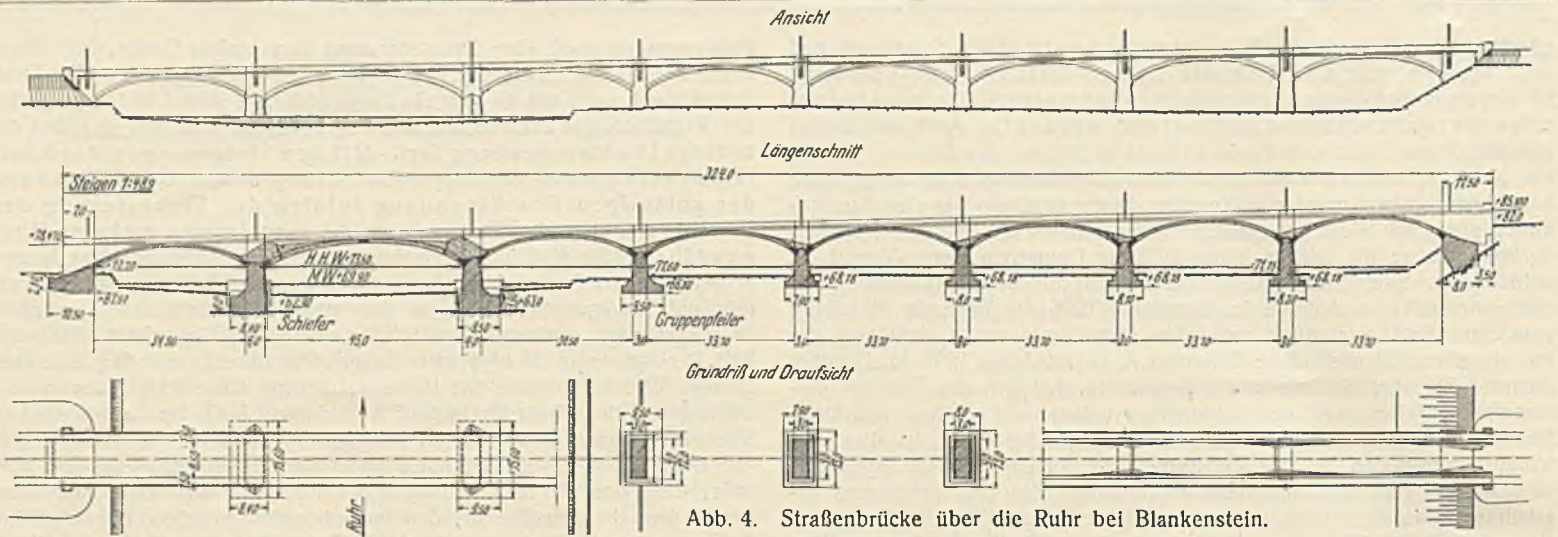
Straßenbrücke über die Ruhr bei Blankenstein.
